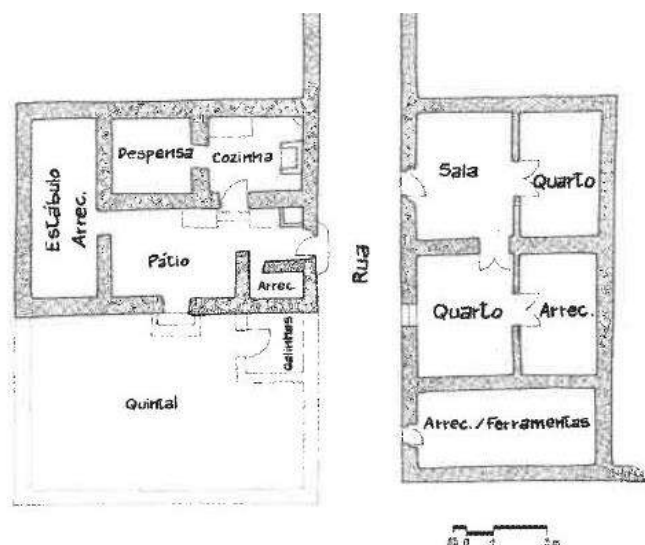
Planta de habitações com relações direta e indireta (por pátio) com o espaço público.
